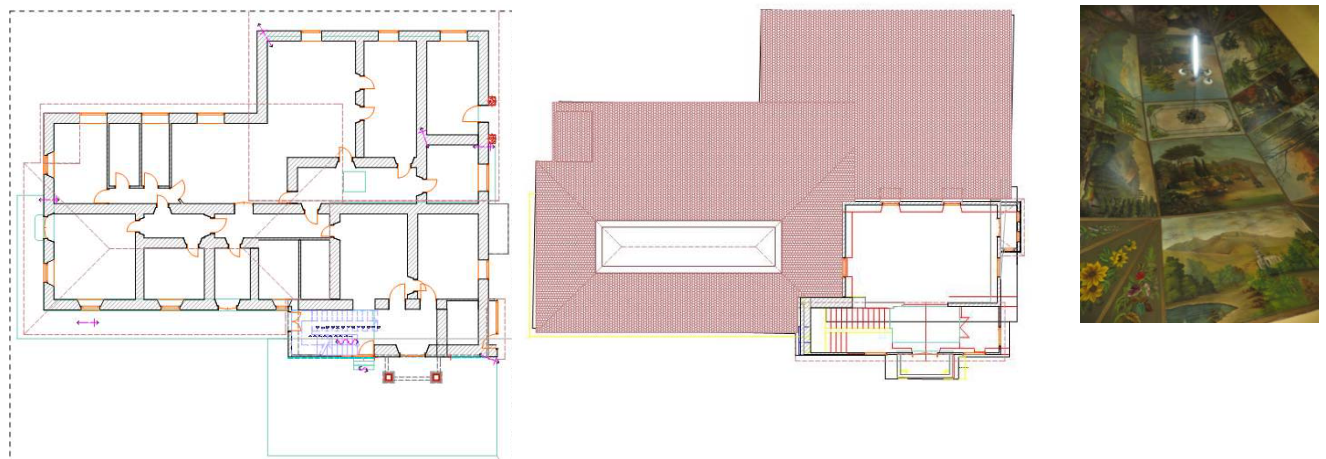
a,b: Pianta piano terra; Pianta primo piano; Fig. 80 c: Soffitto primo piano
